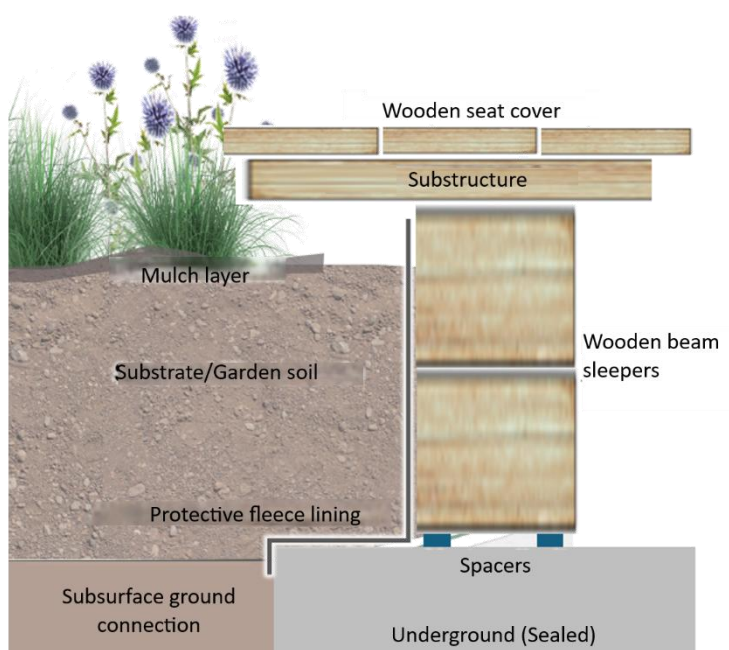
Construcción de la zona de plantación con conexión al suelo, vigas/traviesas de madera y soporte de asiento de madera
